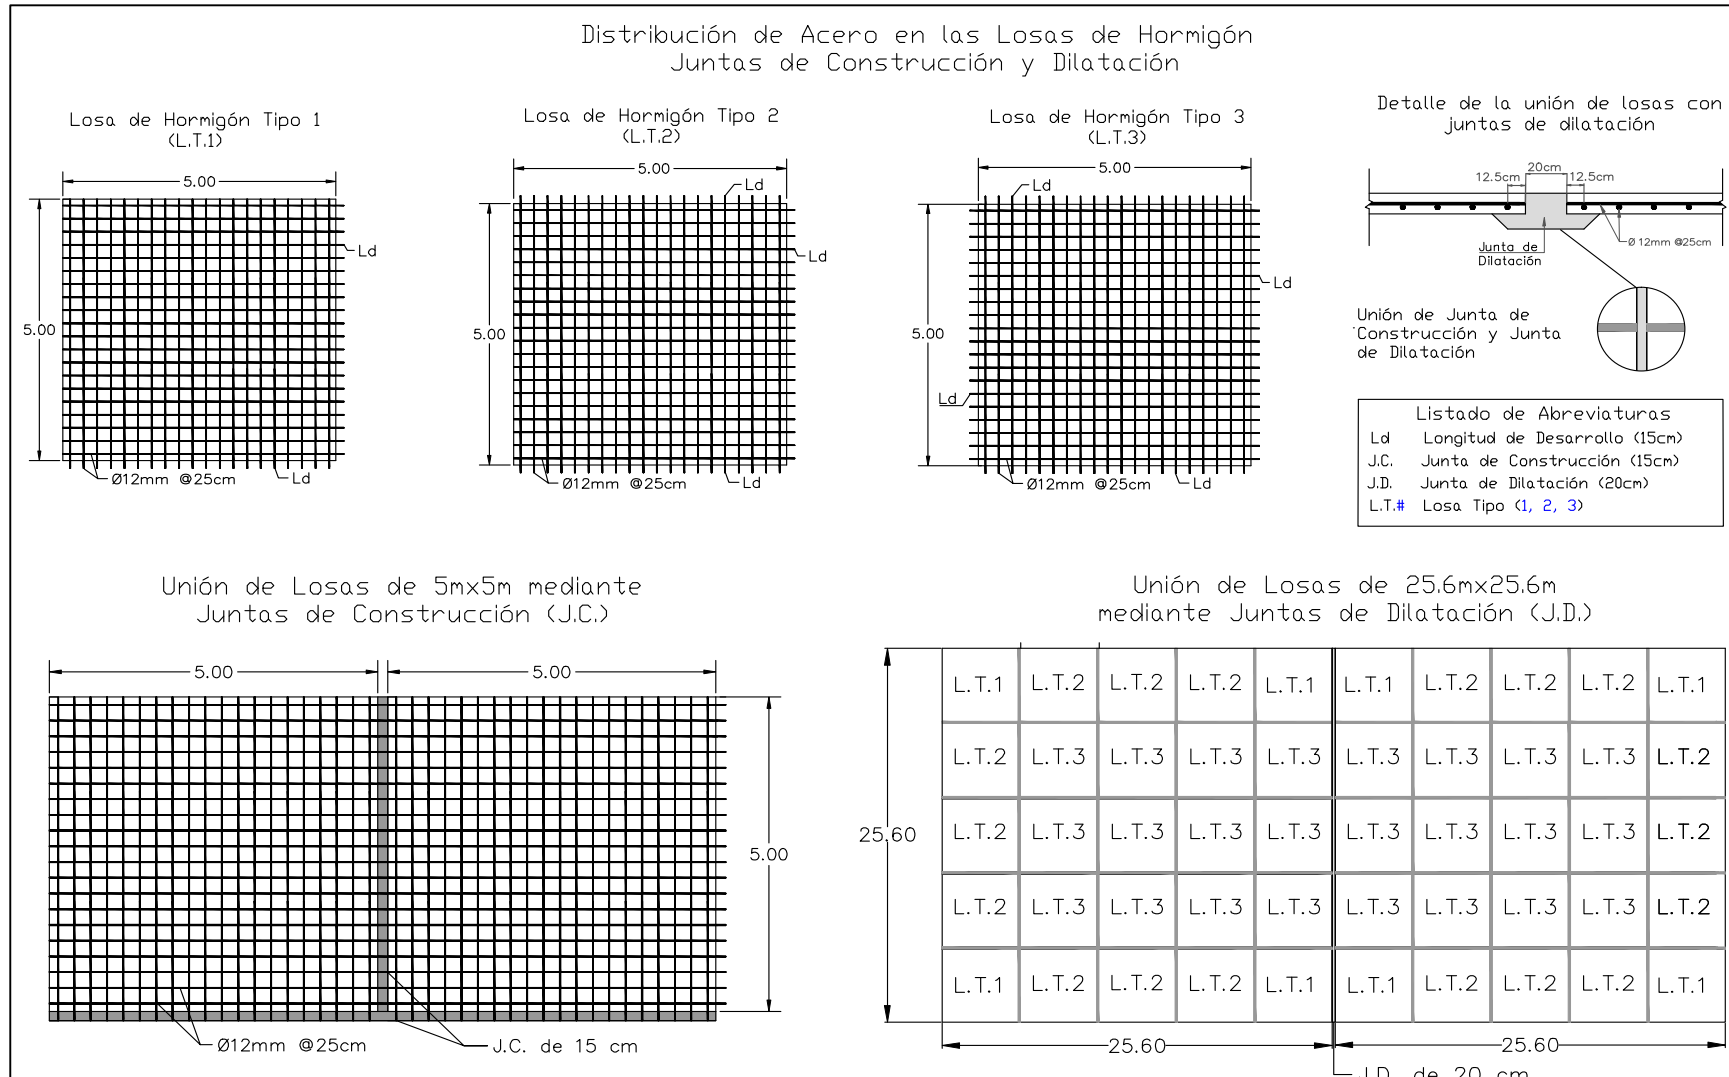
7. Detalle de la distribución de aceros en las losas de hormigón, juntas de construcción y de dilatación
